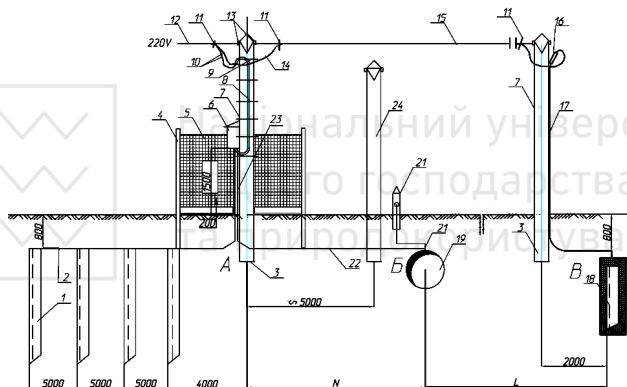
Монтаж СКЗ з випрямлячем, підключеним до ЛЕП з напругою 220 В на трасі трубопроводу:
